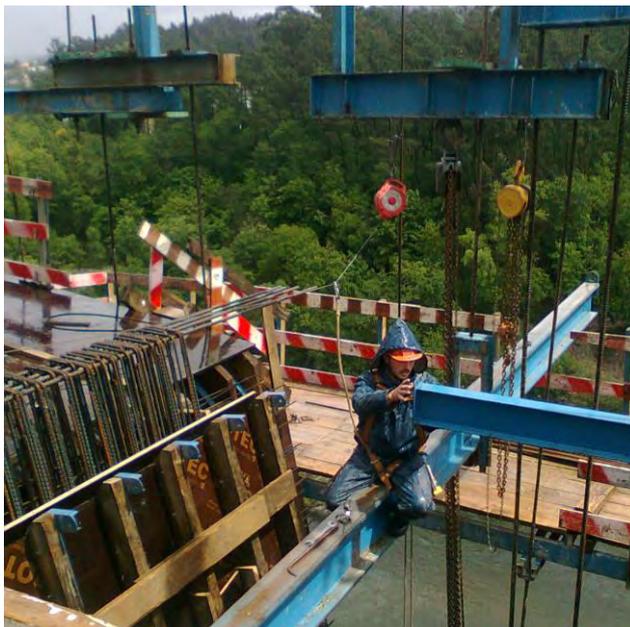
Trabalhador a inserir cavilhas de ligação dos elementos metálicos
